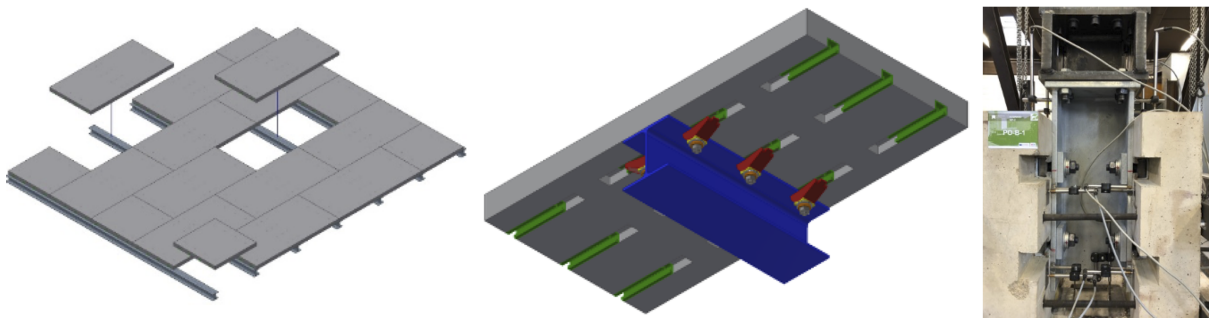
Modulare Bauweise für Verbundkonstruktionen mit demontierbaren Reibungs- und Schraubverbindungen.
